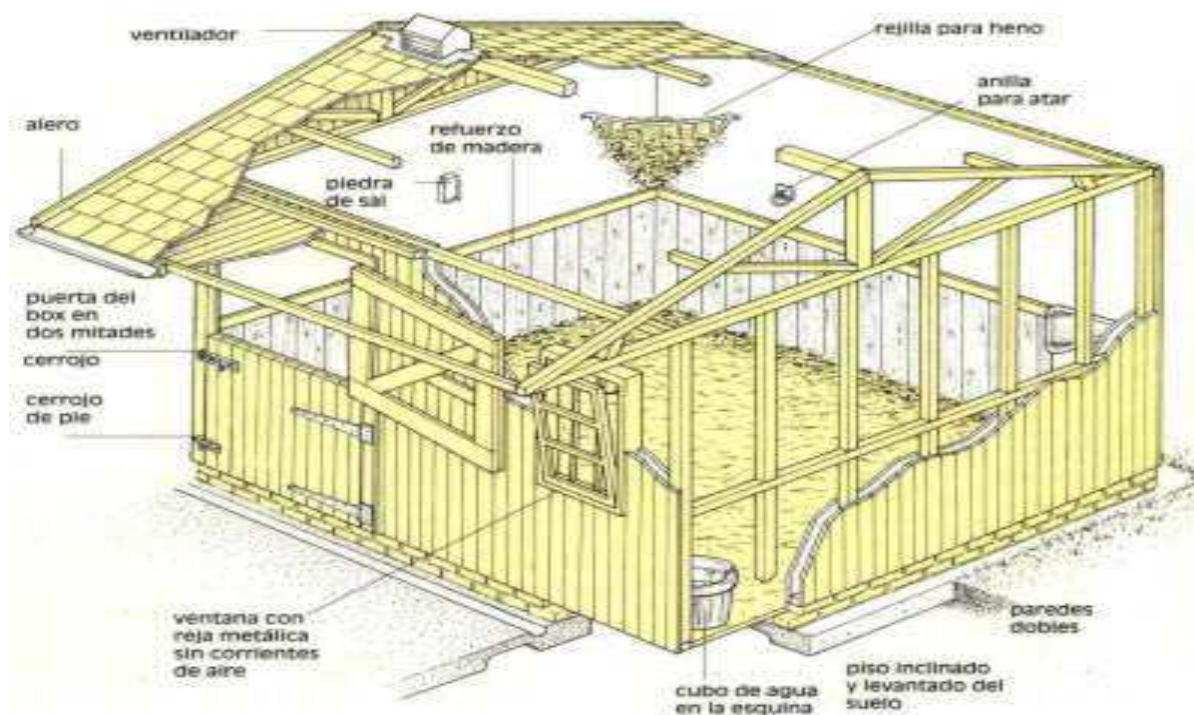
Materiales y equipamiento en un pesebre tradicional. Fuente: Parámetros de construcción para instalaciones equinas. Disponible en: <https://docs.google.com/file/d>
